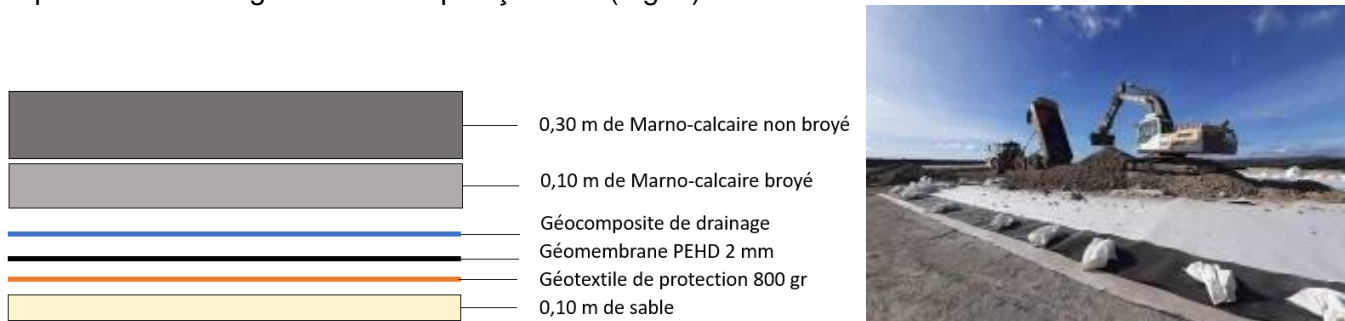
Coupe verticale et vue de la nouvelle structure d'étanchéité
